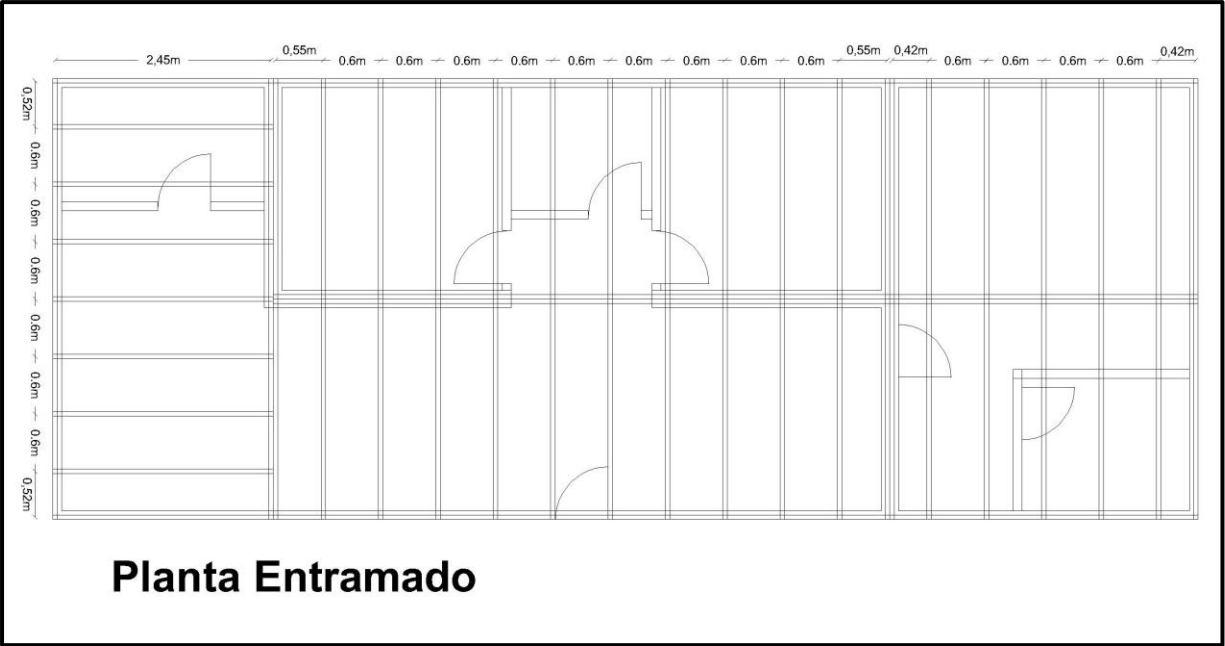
Plano detalle estructura tabique con revestimiento OSB. Elaboración propia.
